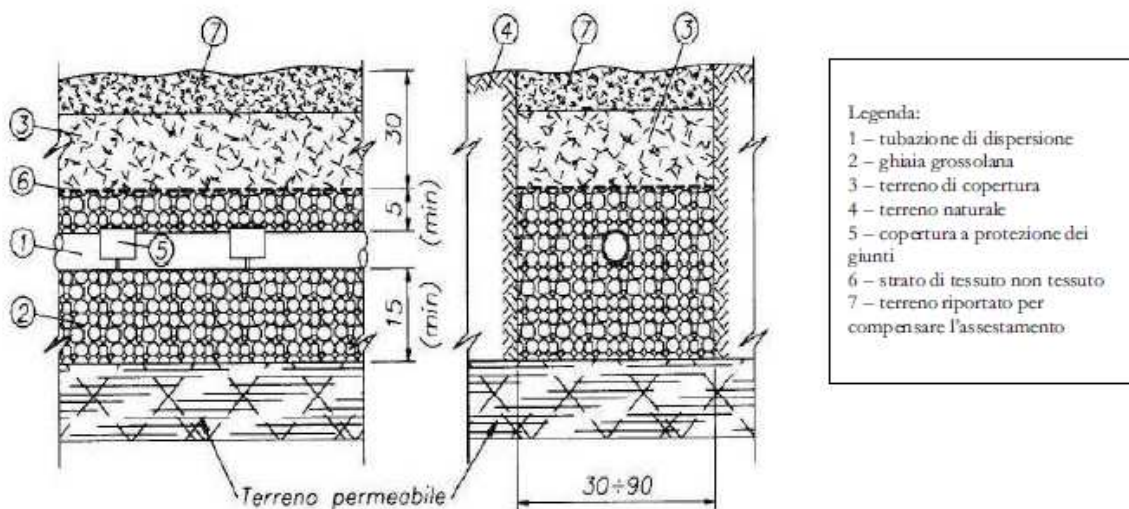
Schema di trincea per la sub-irrigazione nel terreno
